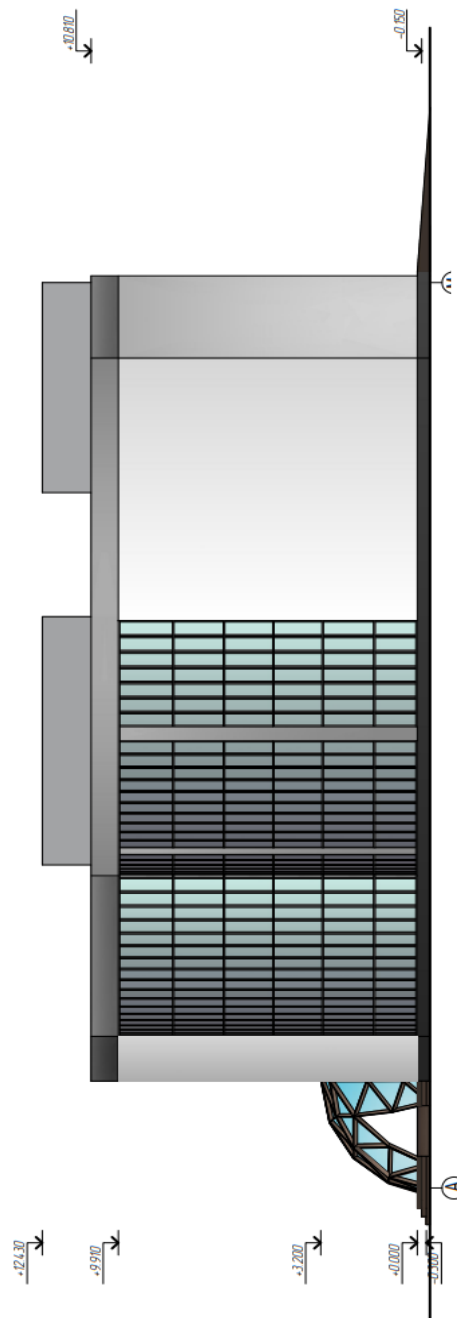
Фасад с дворовой части здания, М 1:100
